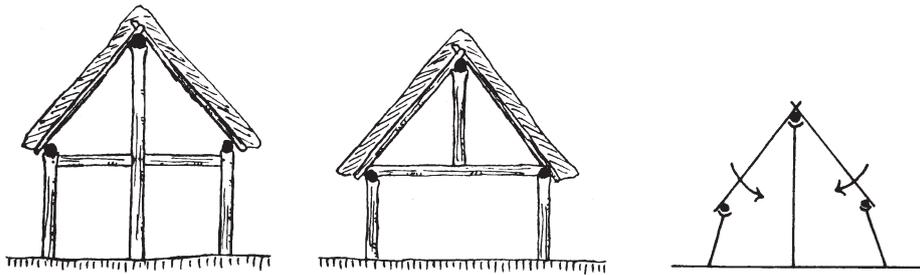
Rofendach mit Firstsäule, Rofendach mit abgefangener Firstsäule, Schubwirkung des Rofendaches (nach BAUMGARTEN 1985, 21, Abb. 6a, c, d).
